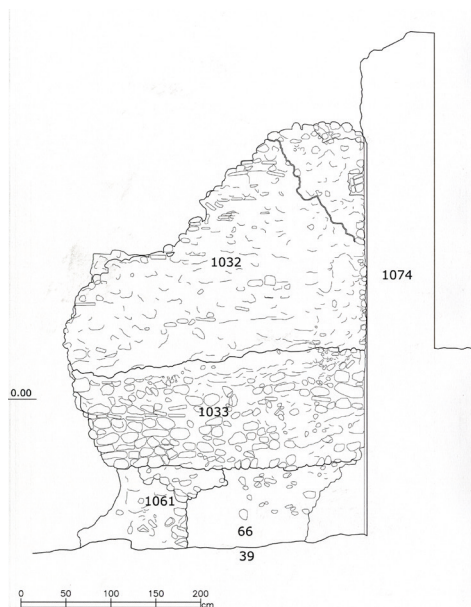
Area dell'arco del Sacramento. Muro 1032-1033, prospetto ovest.
